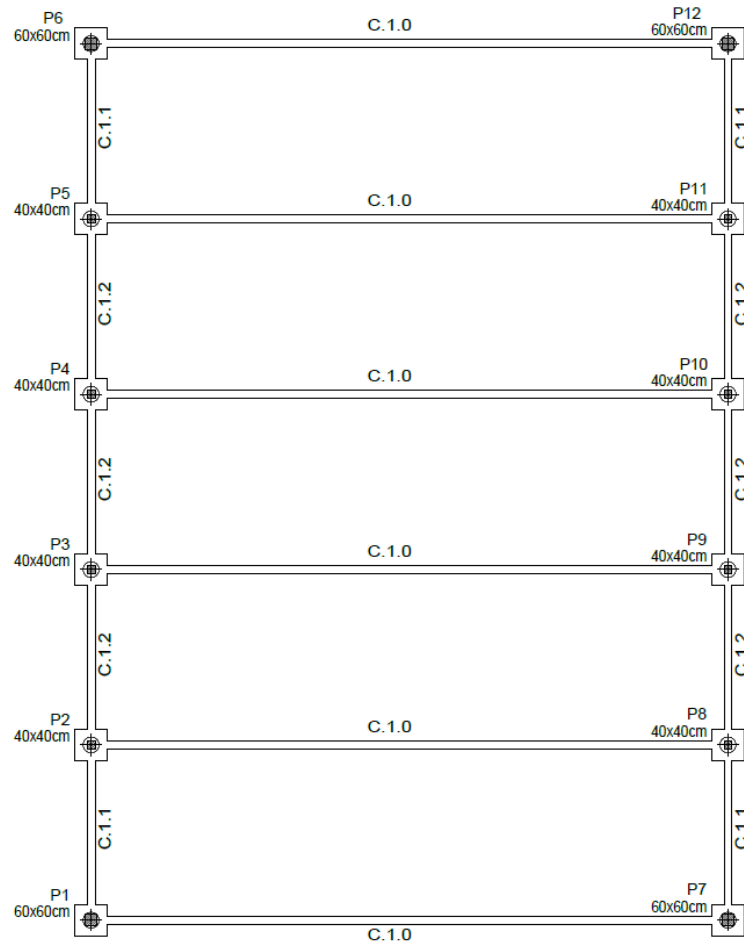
Distribución en planta de los encepadas y pilotes. Fuente: Elaboración propia
